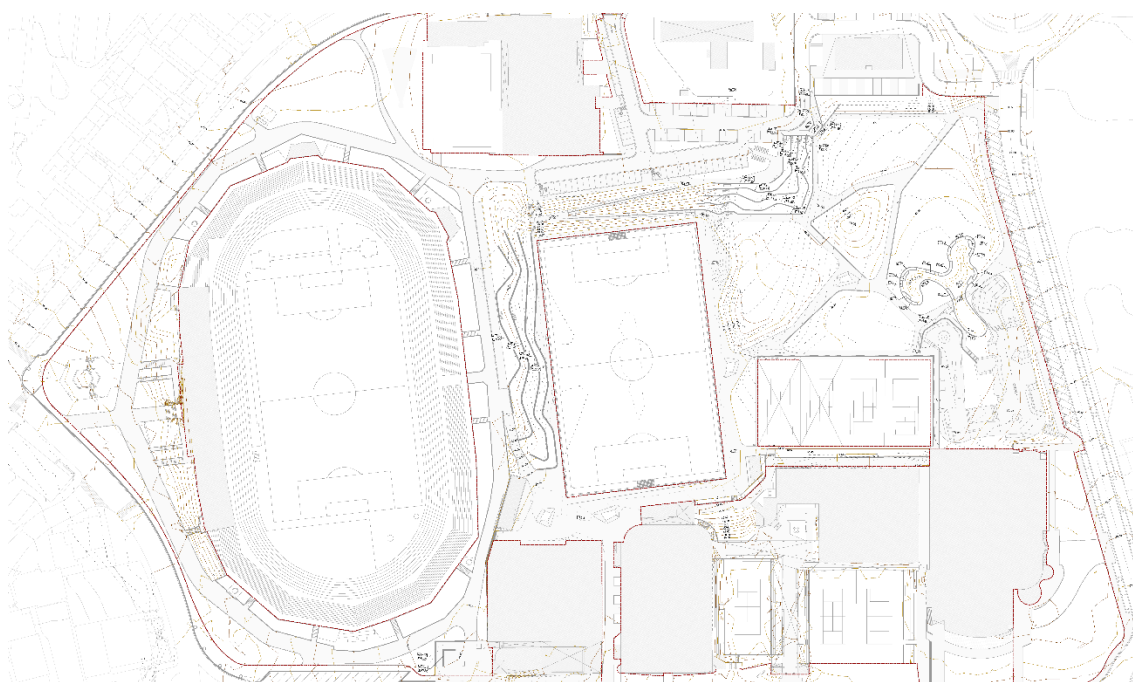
Modelação de terreno do Parque da Maia Fonte: Adaptado de LR | Arquitetura Paisagista.
